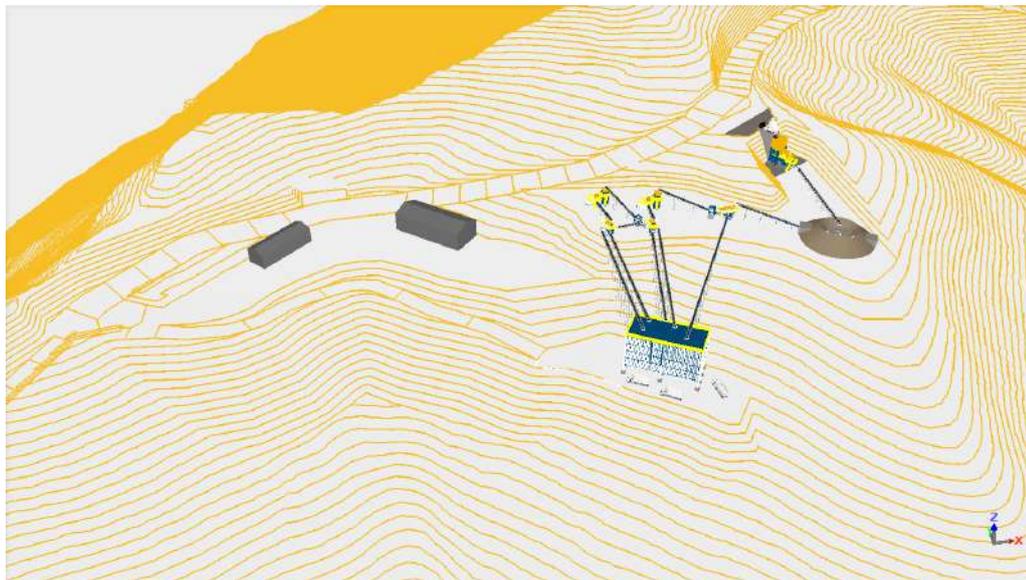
Alternativa 1 de ubicación de planta en relleno
